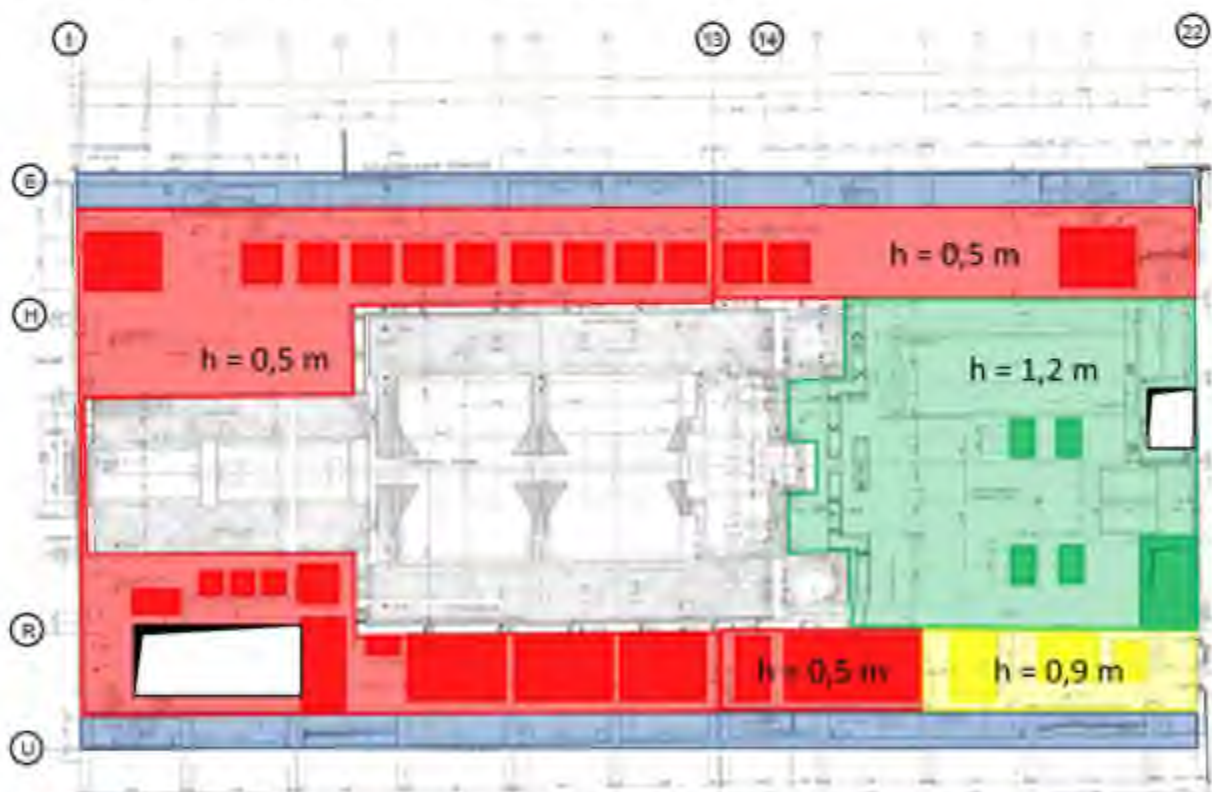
Grundrisssskizze der Ebene ZF05 (Höhenkote +19,0 m) des Maschinenhauses mit Markierung der Bereiche mit unterschiedlichen Bauteildicken und der mit Betonplatten abgedeckten Bereiche
